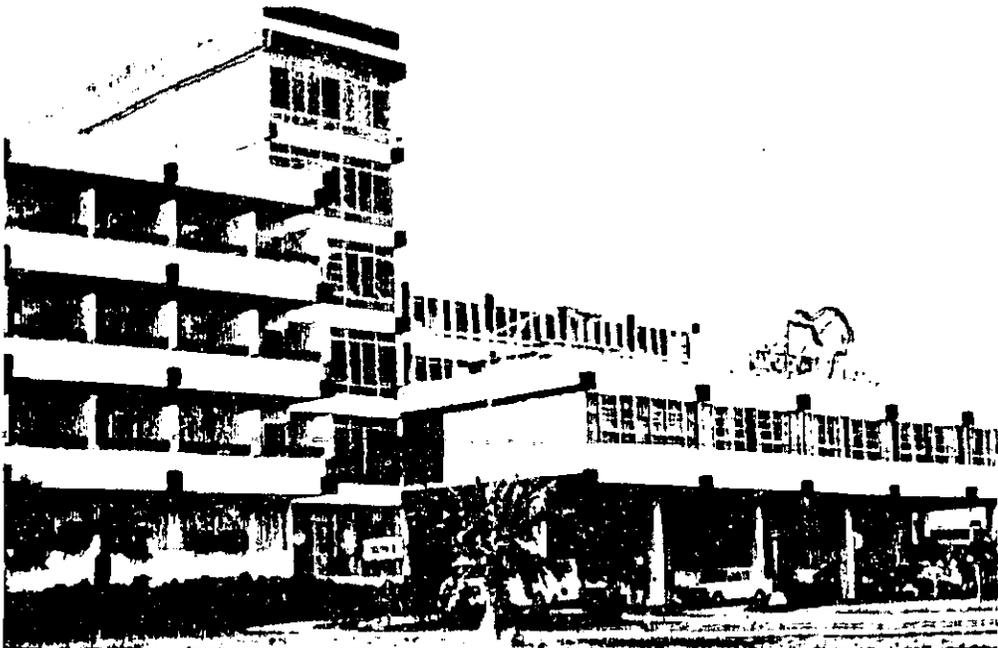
Hotel Atabey en Varadero, construido con Sistema Girón.
